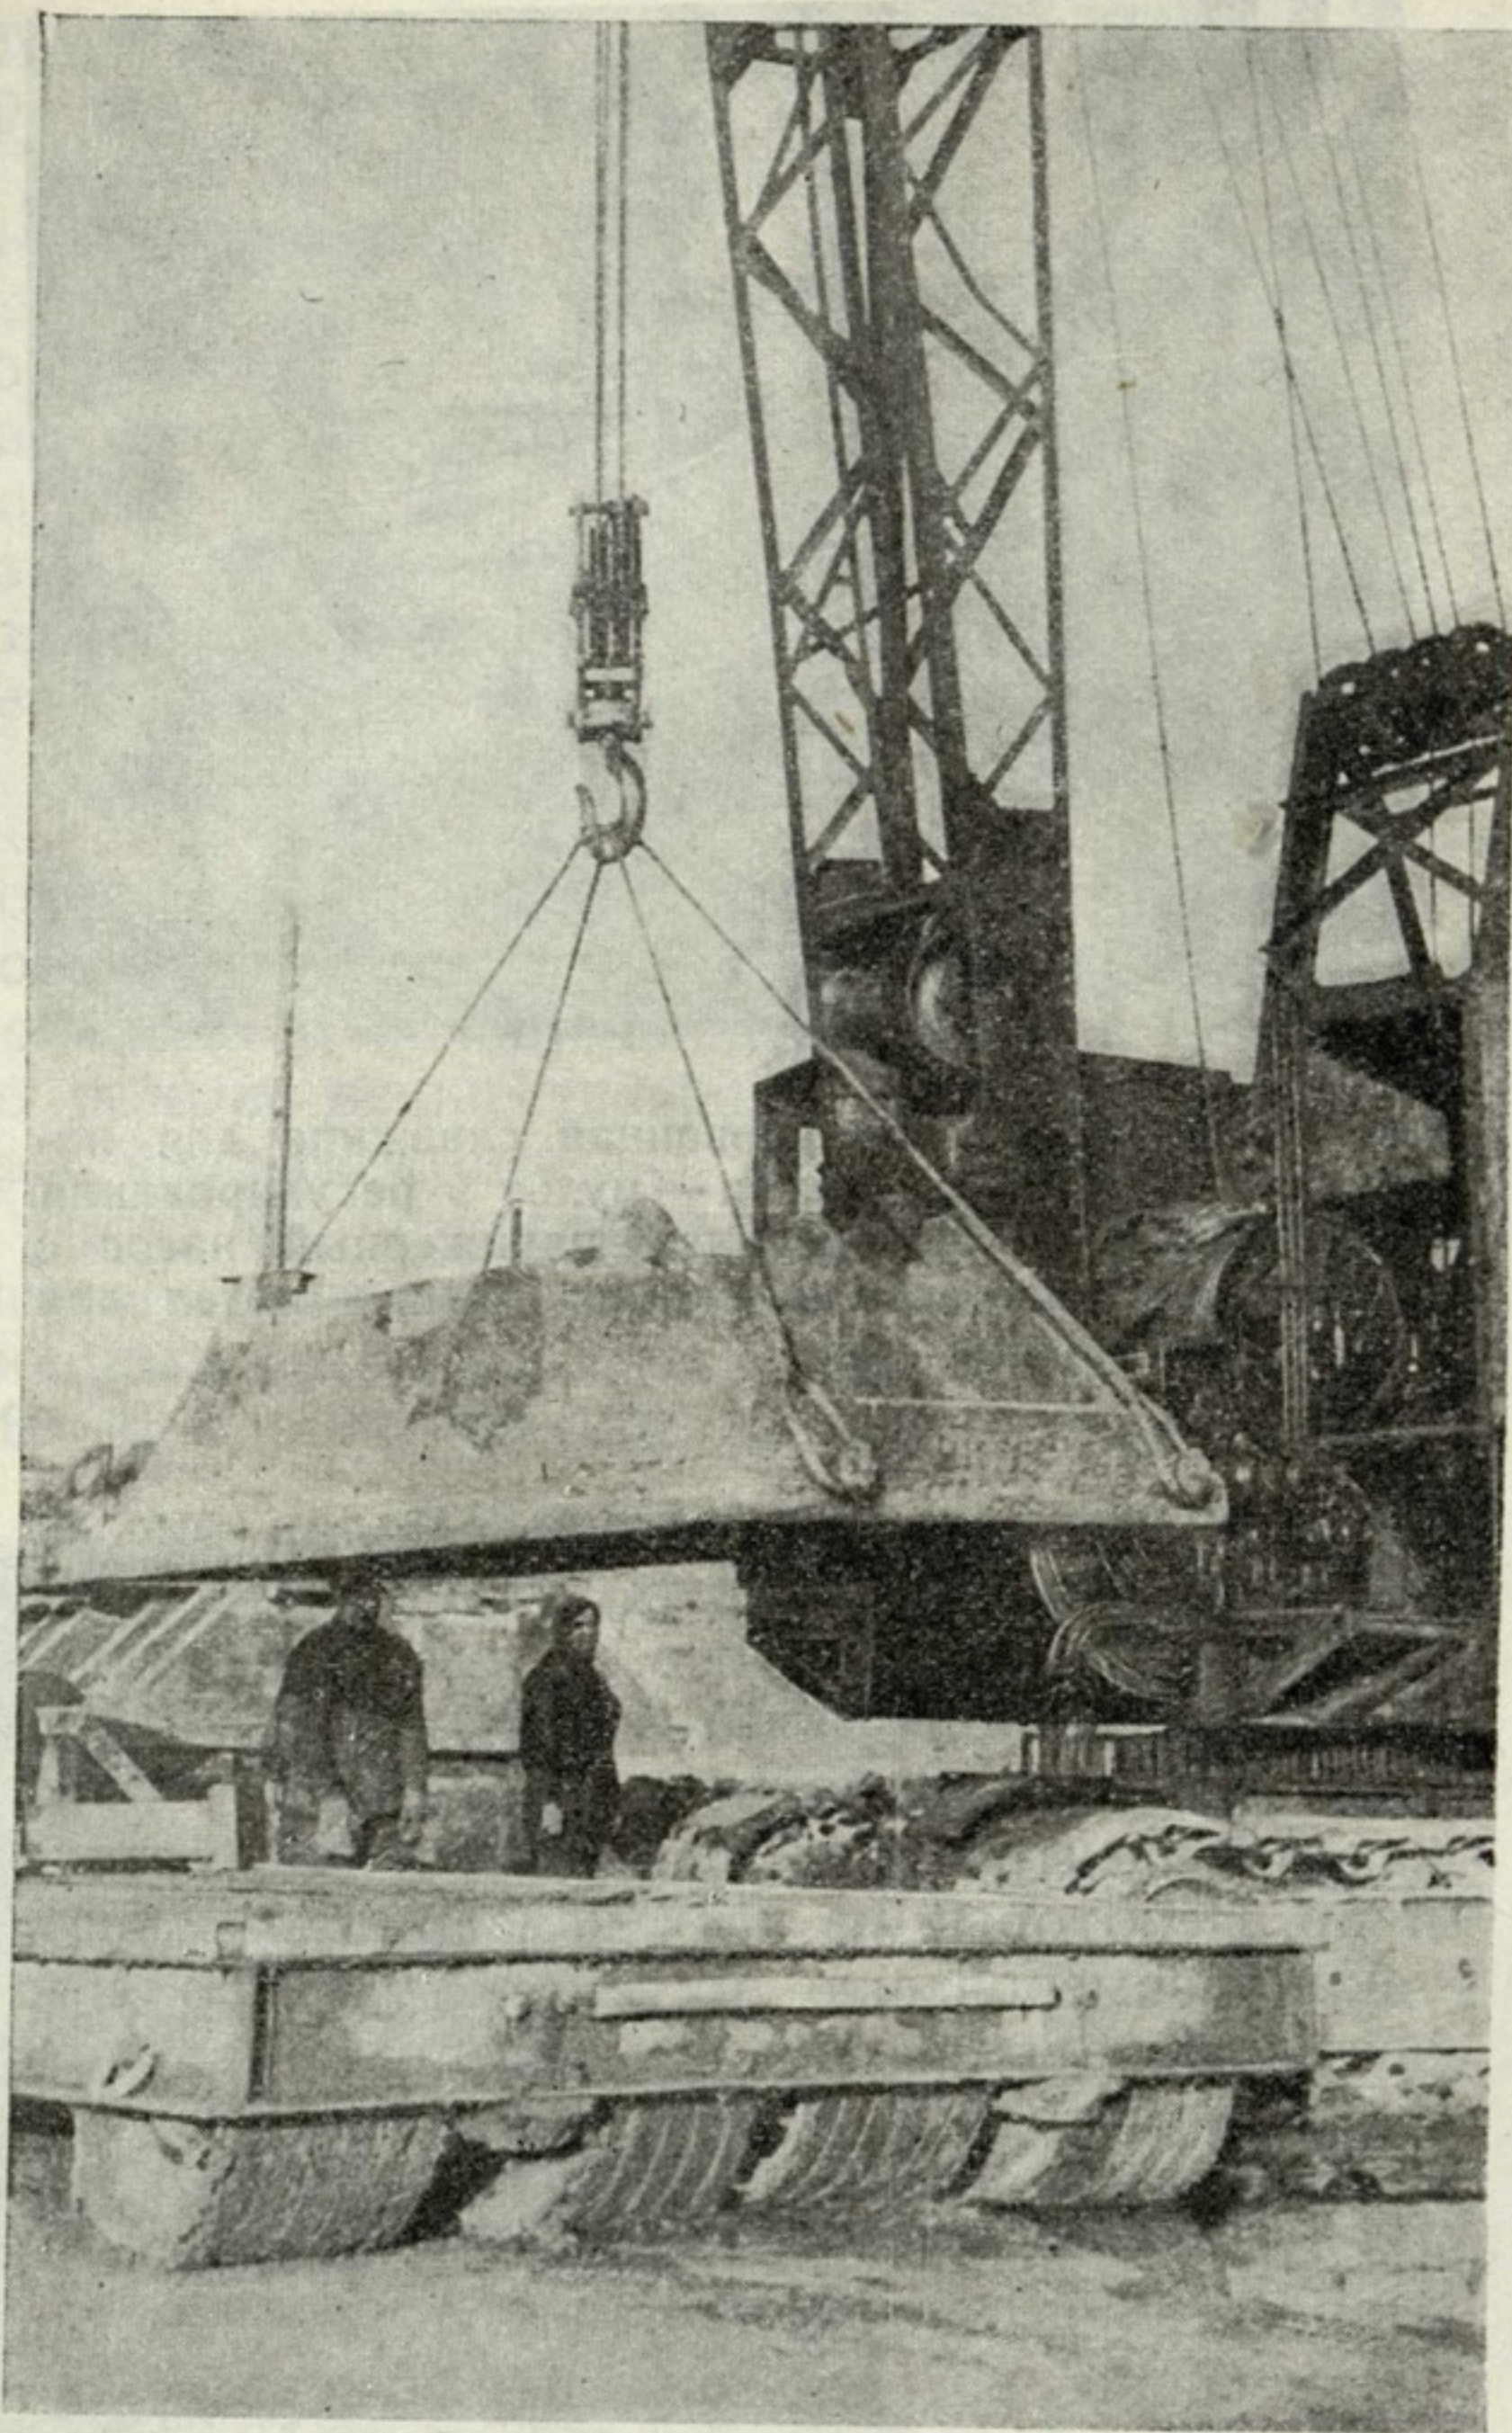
Установка с помощью крана «Индустриал» литой стальной плиты под башмак одной из главных колонн высотной части. На переднем плане — 15-тонный трейлер, на котором доставляются плиты.
